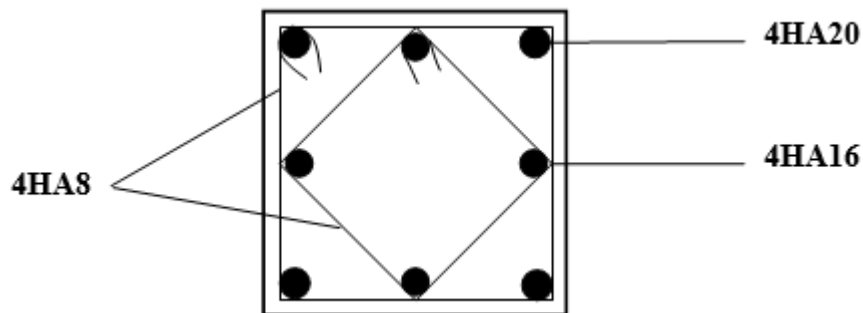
Schéma de ferrailage du poteau RDC.
